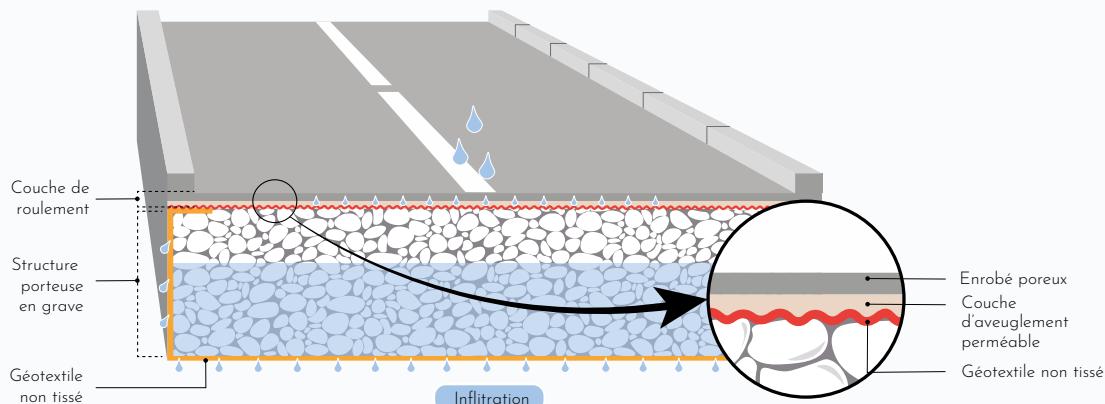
Schéma en profil d'une chaussée à structure réservoir.
